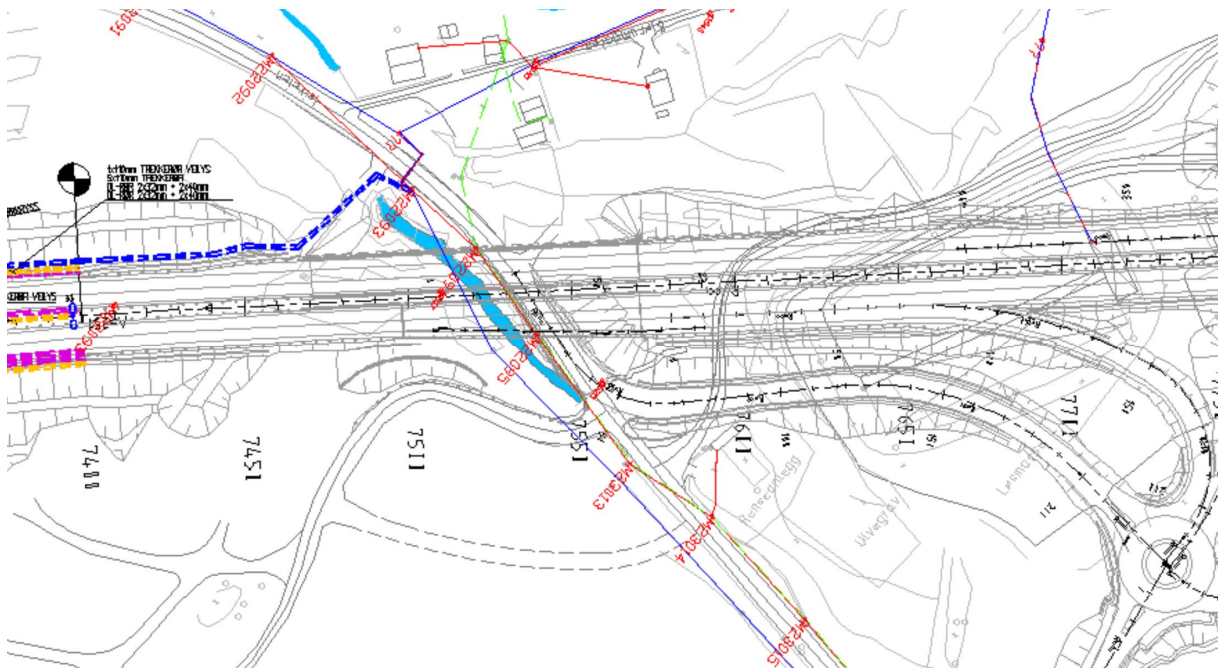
Drensplan for eksisterende E16. Strømningsretning for vegvann er vist med røde piler.
